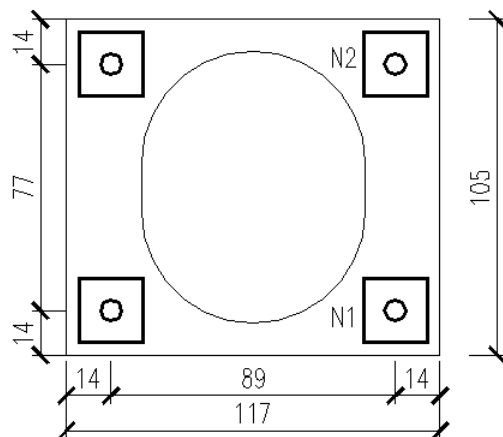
钢束中板-支 (尺寸单位:cm)
